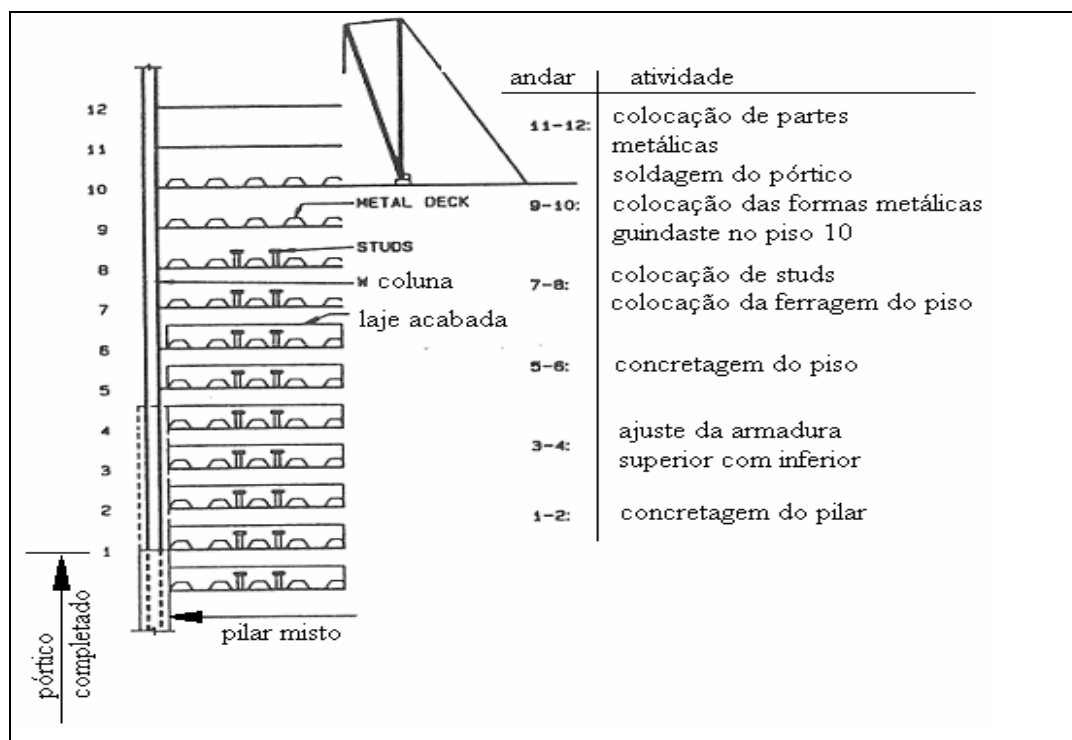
Fases de montagem- estrutura c/ pilar e laje mistos(AISC-Steel design).
